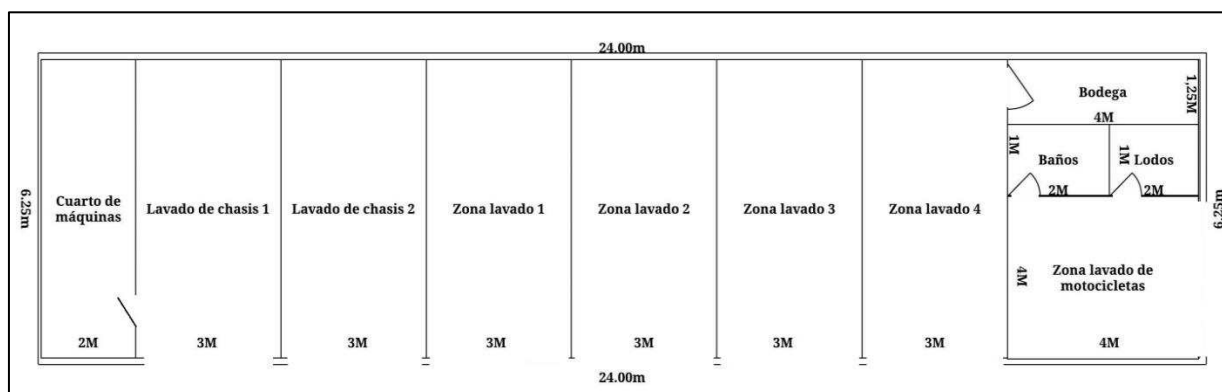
Propuesta distribución de planta primer piso auto lavado Patio Uno. Elaboración propia.
